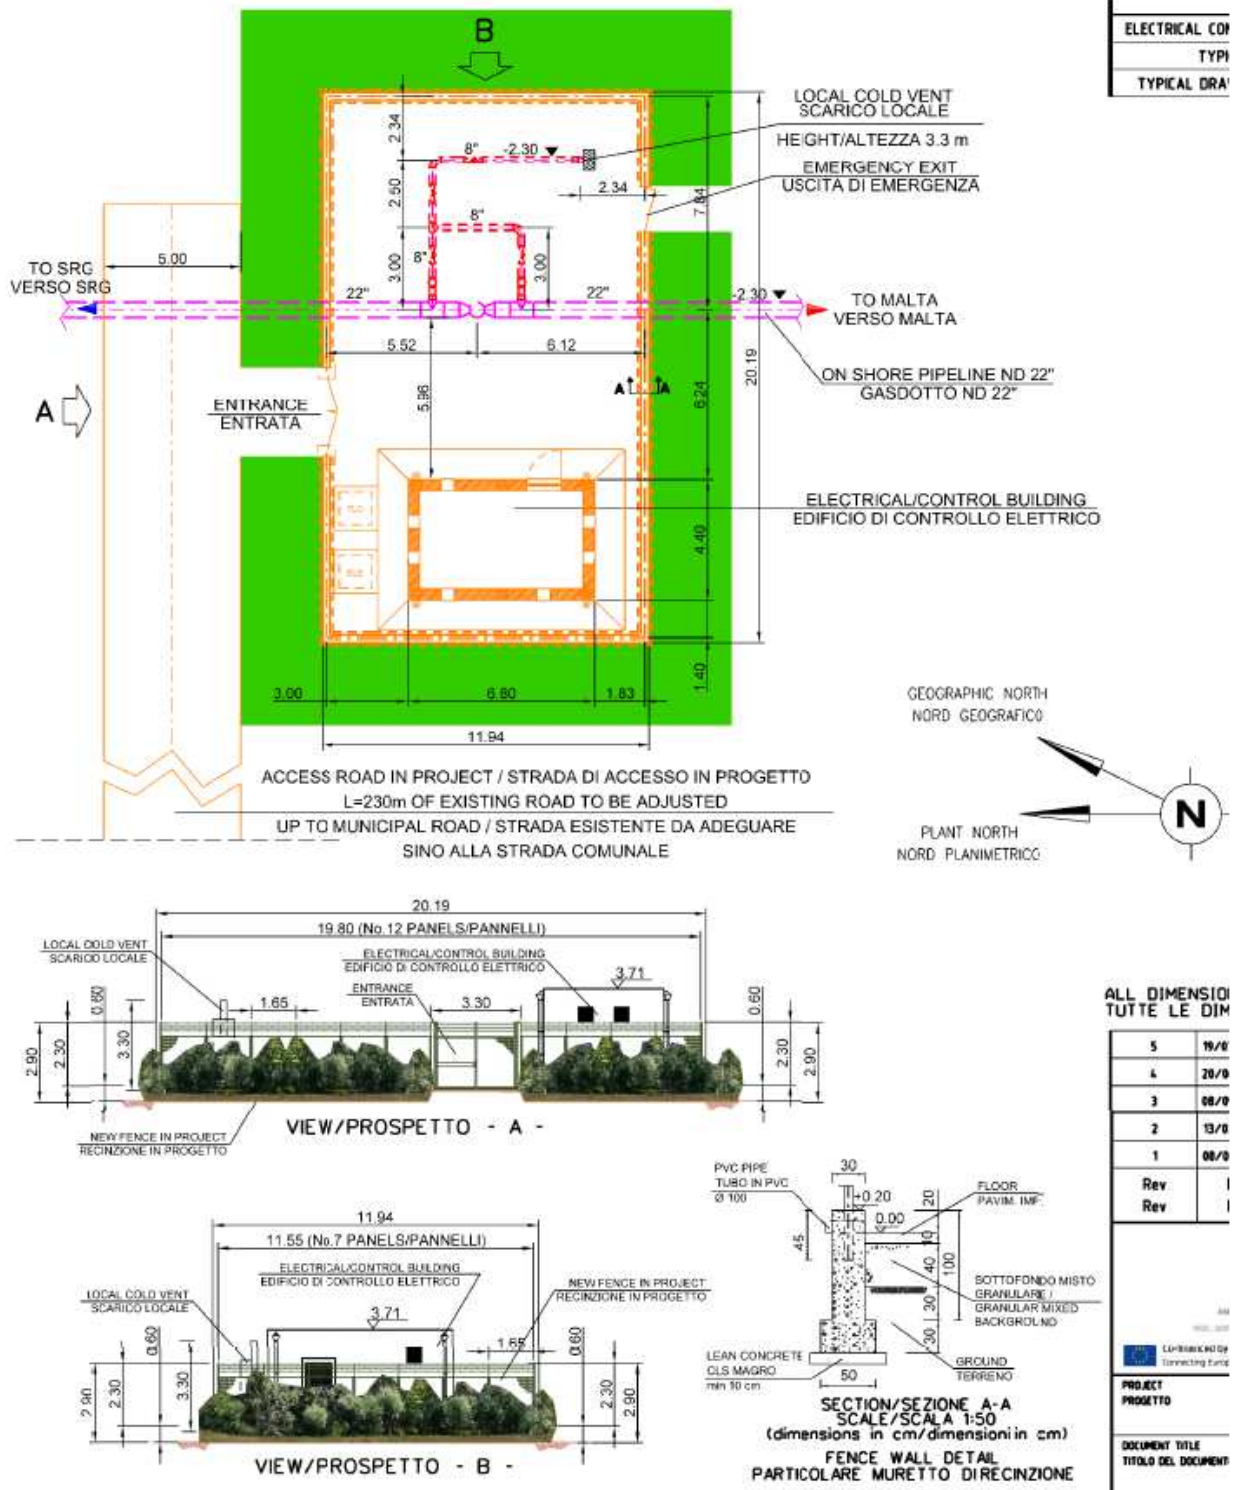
Punto di intercettazione di linea 1 – Planimetria e prospetti
